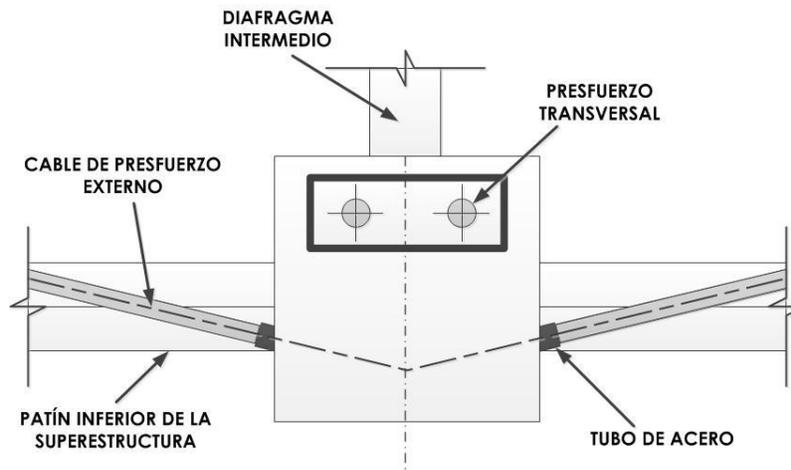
Esquema de un bloque desviador (Academia Mexicana de Ingeniería, 1999)
